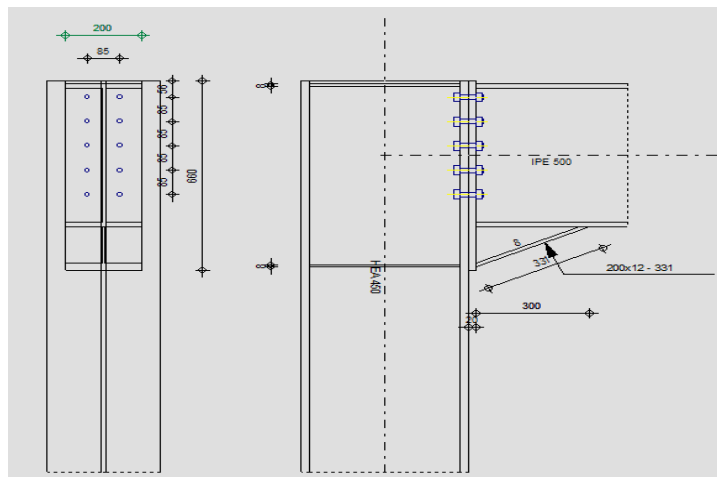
Detaille d'Assemblage poteau poutre
